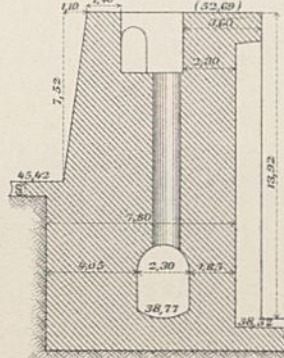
Grundriss d. landseitiger Kammerwände.
